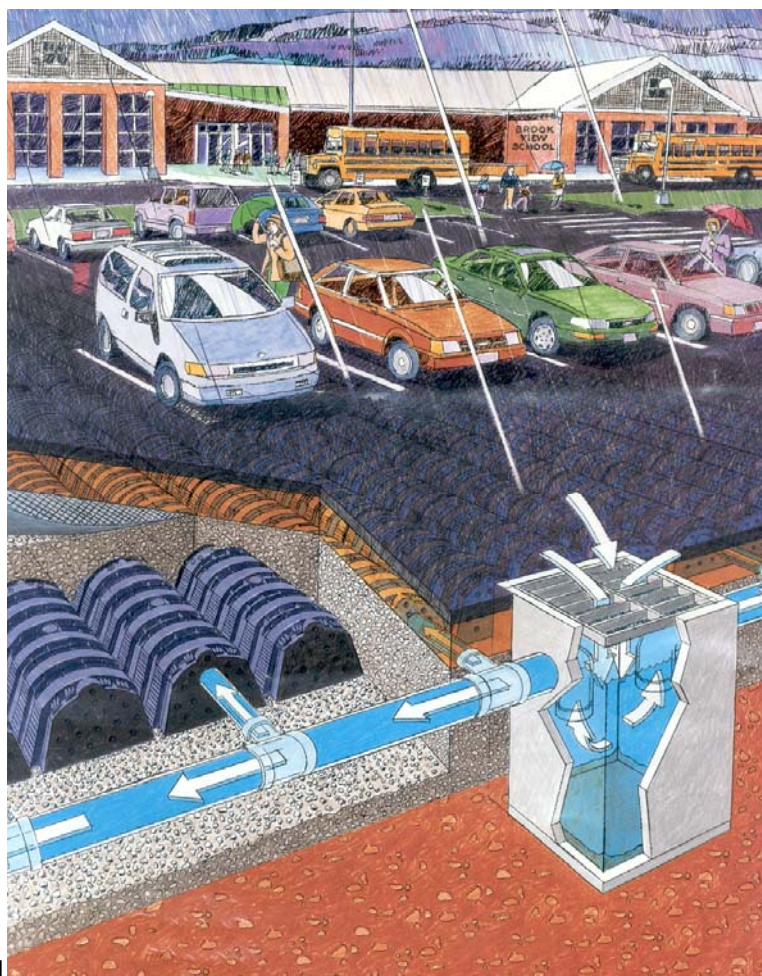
Aplicação do *Infiltrator* em um estacionamento de veículos. As águas pluviais vão para a caixa que as distribui para as câmaras de infiltração.
